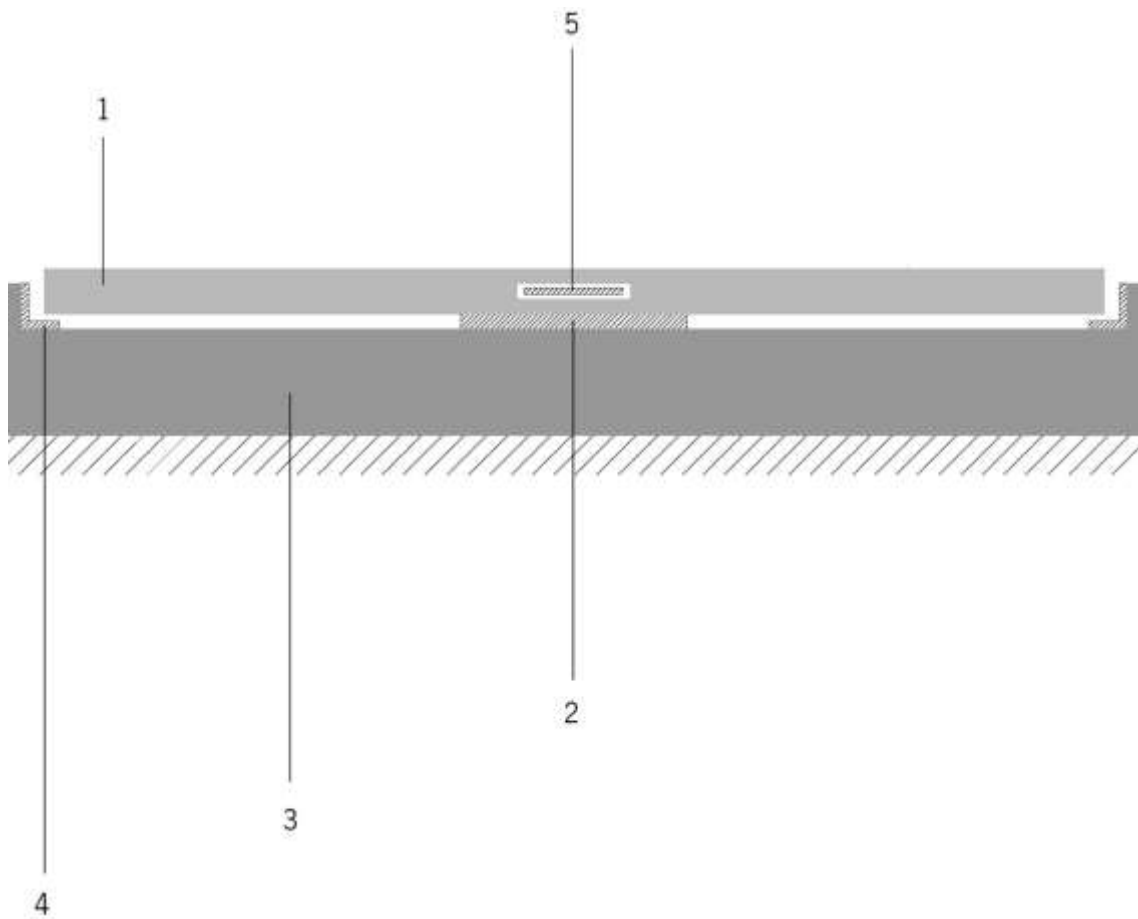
Pormenor construtivo da ardósia. Escala 1/5
